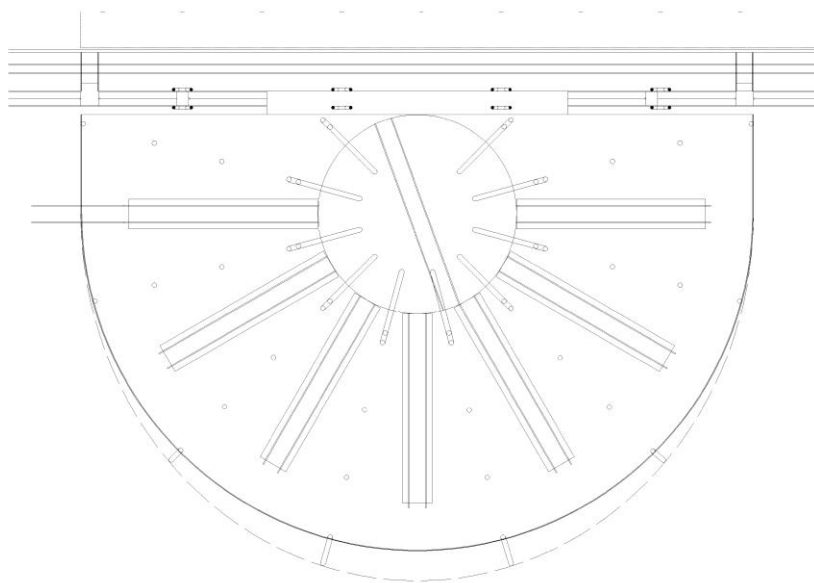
Plantas baixa, plataformas e rotunda (detalhe)
